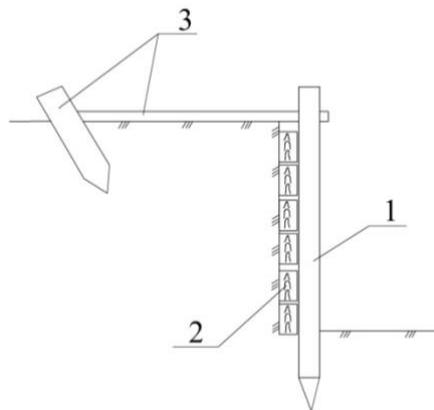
19. Схема анкерного крепления стенки выемки:
